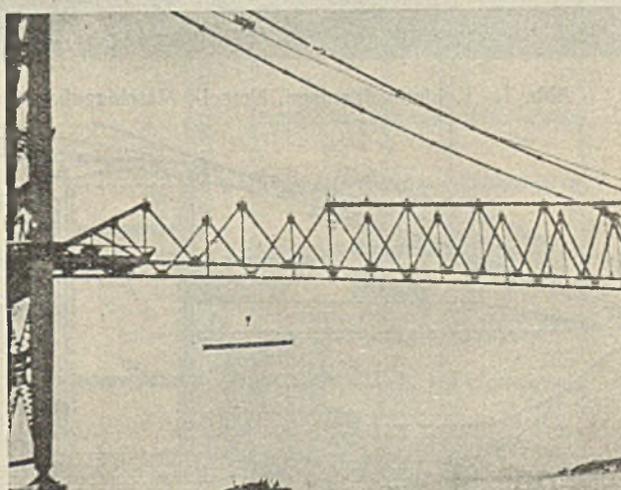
Zusammenbau des Versteifungsträgers mit Hilfe eines Baukabels.
